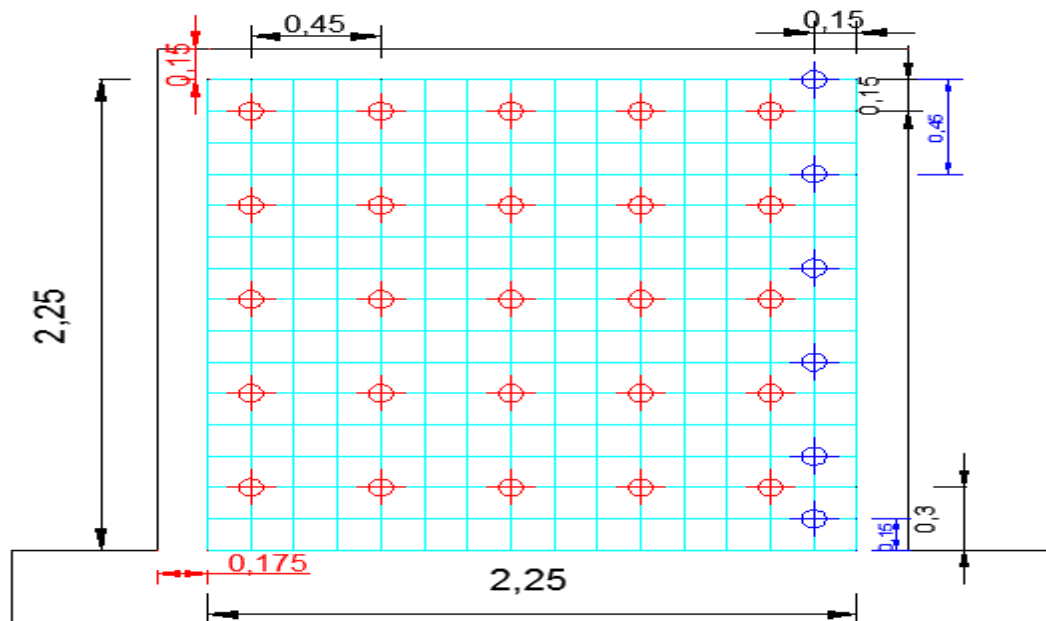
Ejemplo de distribución de las varillas de acero en un muro.
